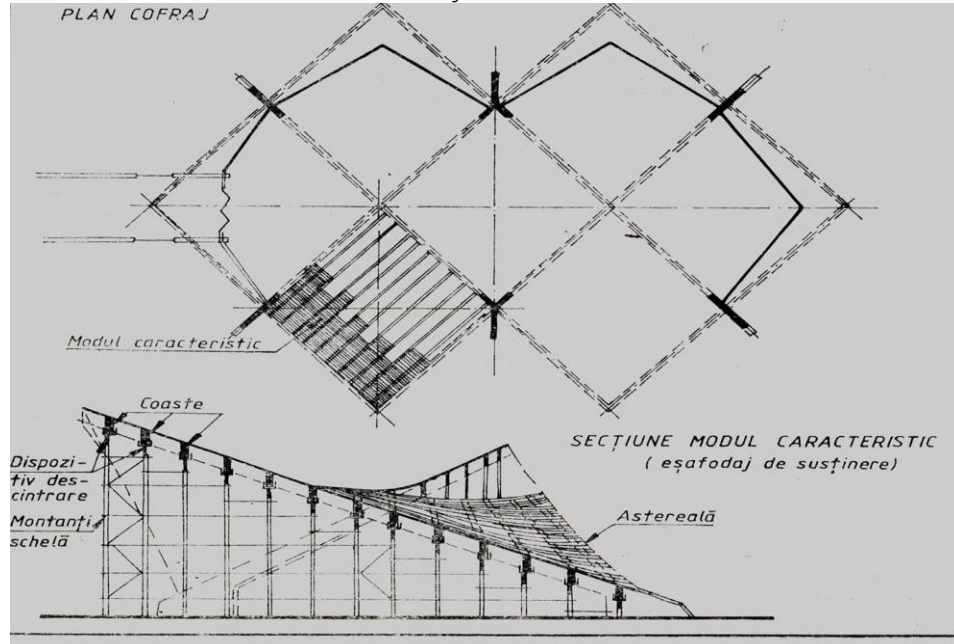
Structură de susținere și cofraj din lemn pentru executarea unei plăci curbe subțiri din beton armat.
